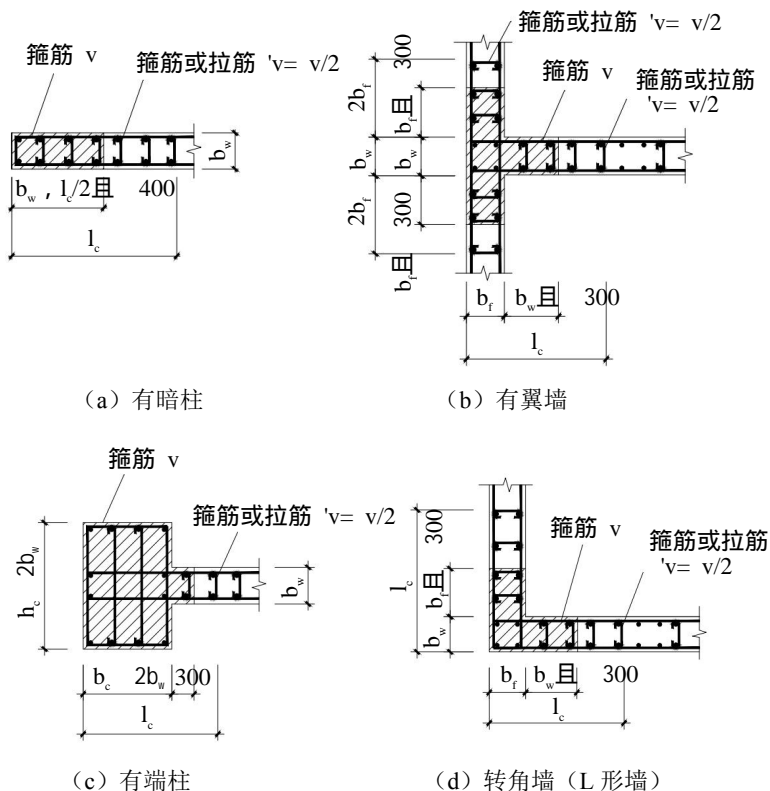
预制剪力墙的后浇混凝土约束边缘构件示意
